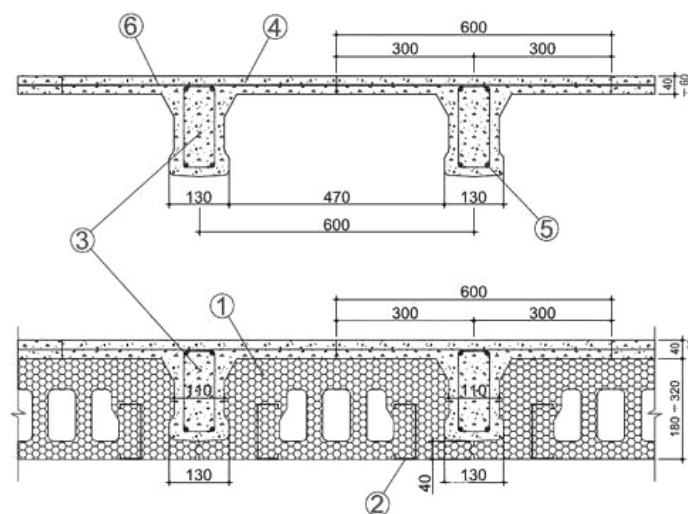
Ребристе перекриття, створене з використанням незнімної опалубки: 1 – незнімна опалубка перекриття; 2 – оцинкований сталевий U-профіль; 3 – залізобетонні ребра перекриття; 4 – залізобетонна плита перекриття; 5 – робоча арматура ребер; 6 – арматура плити.
